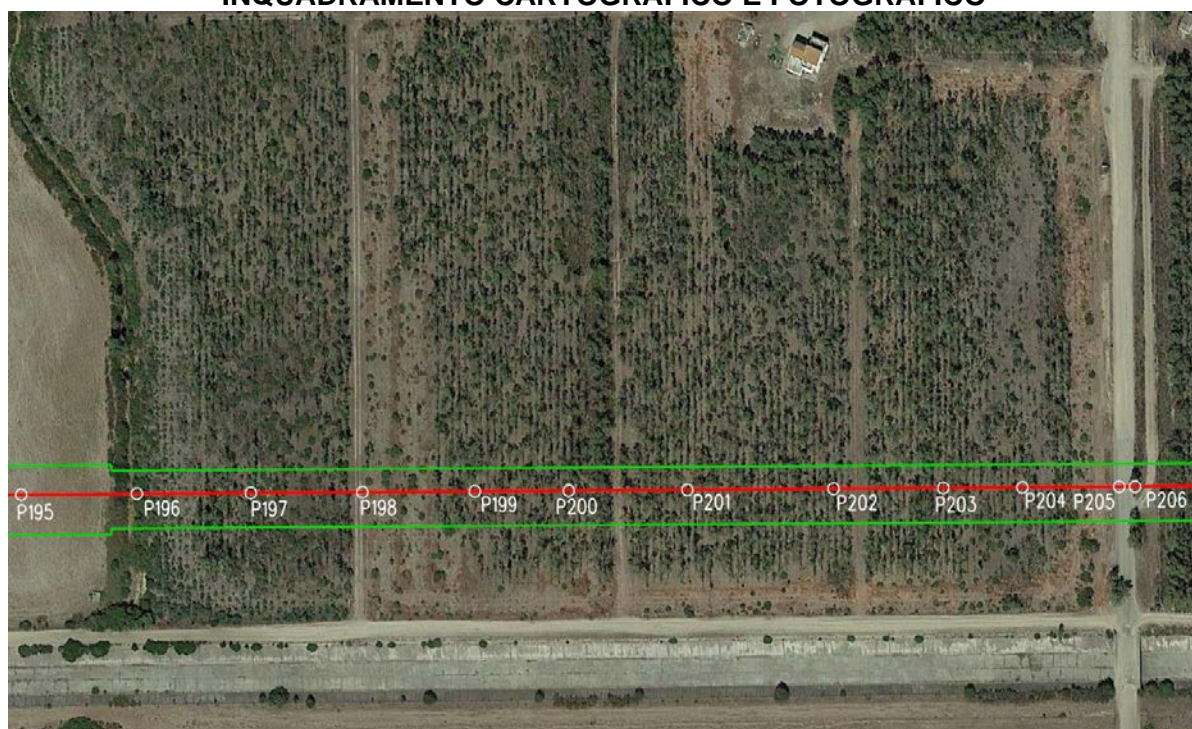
Tratto P196 – P205 - la zona delimitata dalle linee verdi rappresenta la fascia ristretta di lavoro per come previsto dalla GASD C 13.40.10.02
